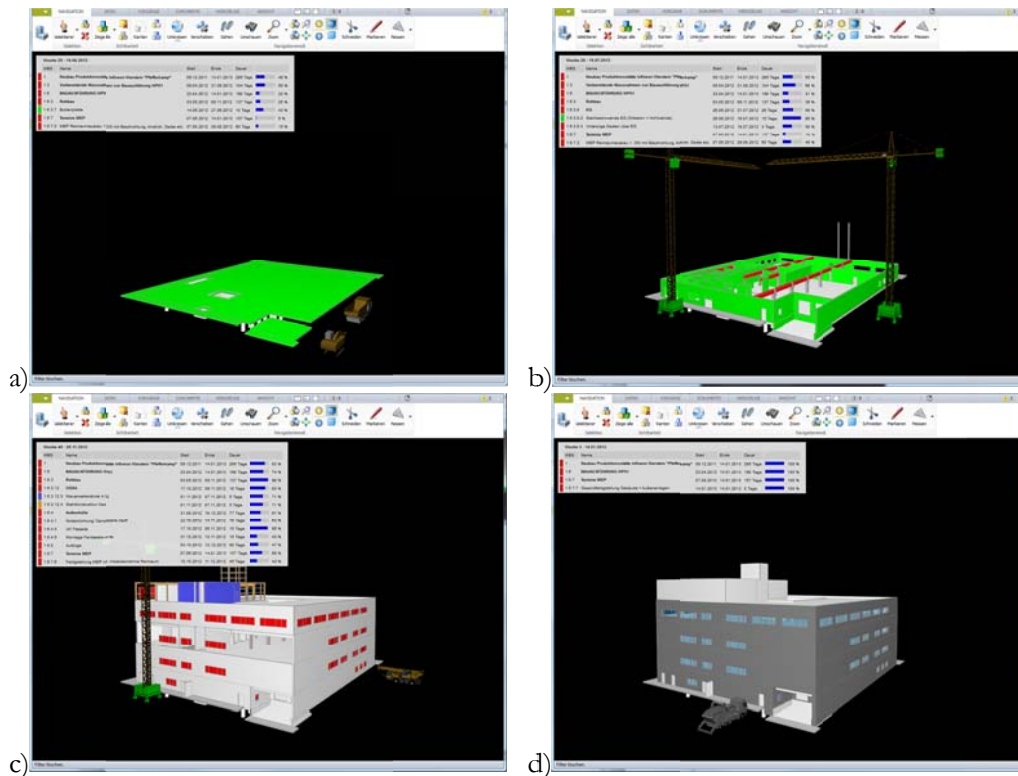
Bauablaufmodell (4D-Modell) mit Baustelleneinrichtungselementen
